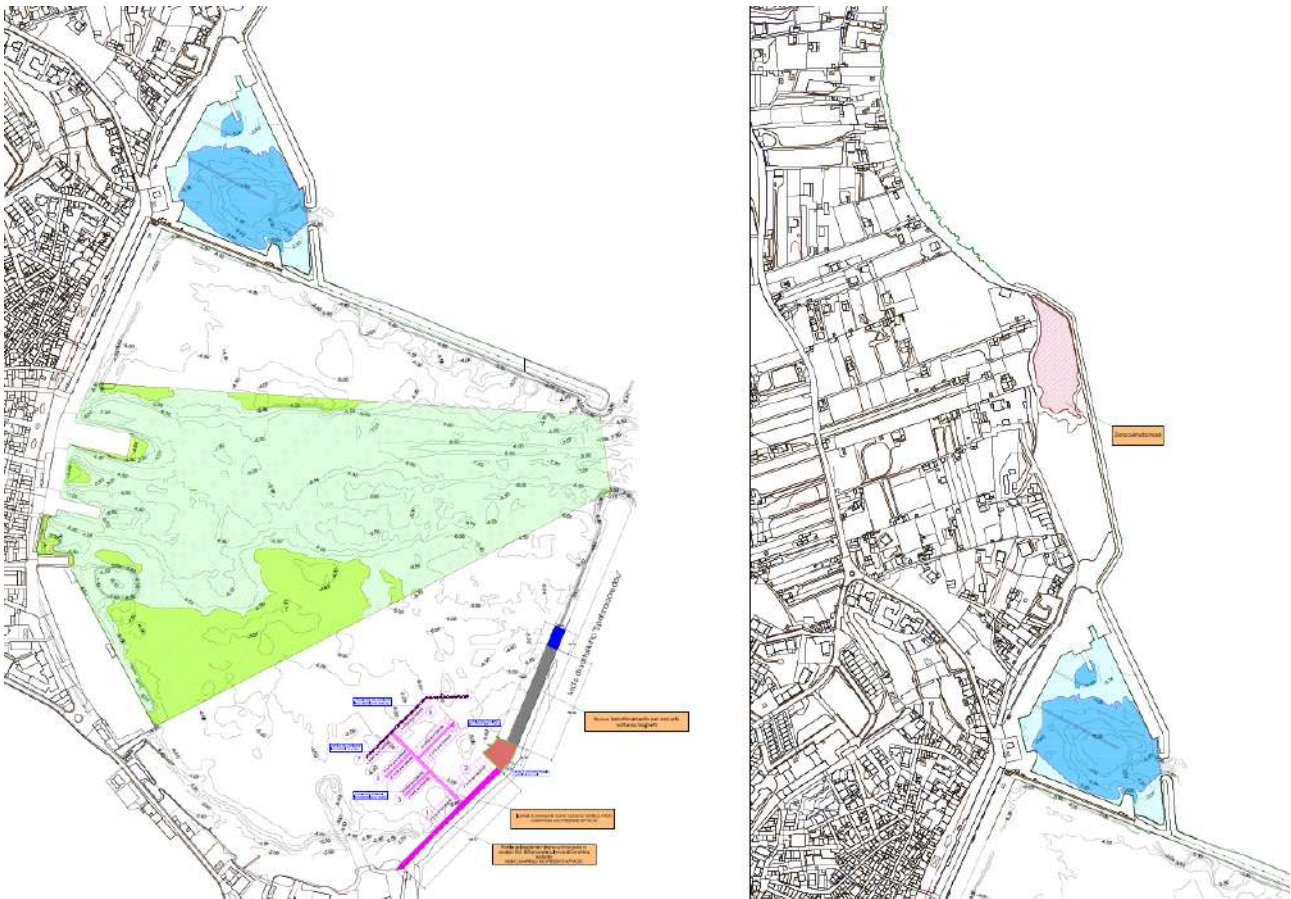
Interventi di potenziamento del Porto di Carloforte – planimetria di progetto
